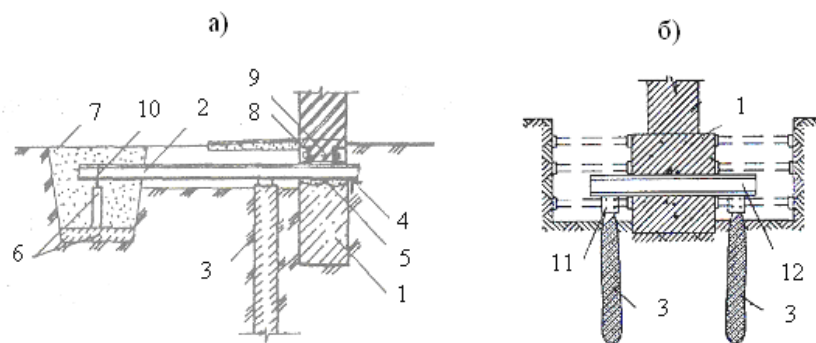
Усиление ленточных фундаментов выносными сваями:
